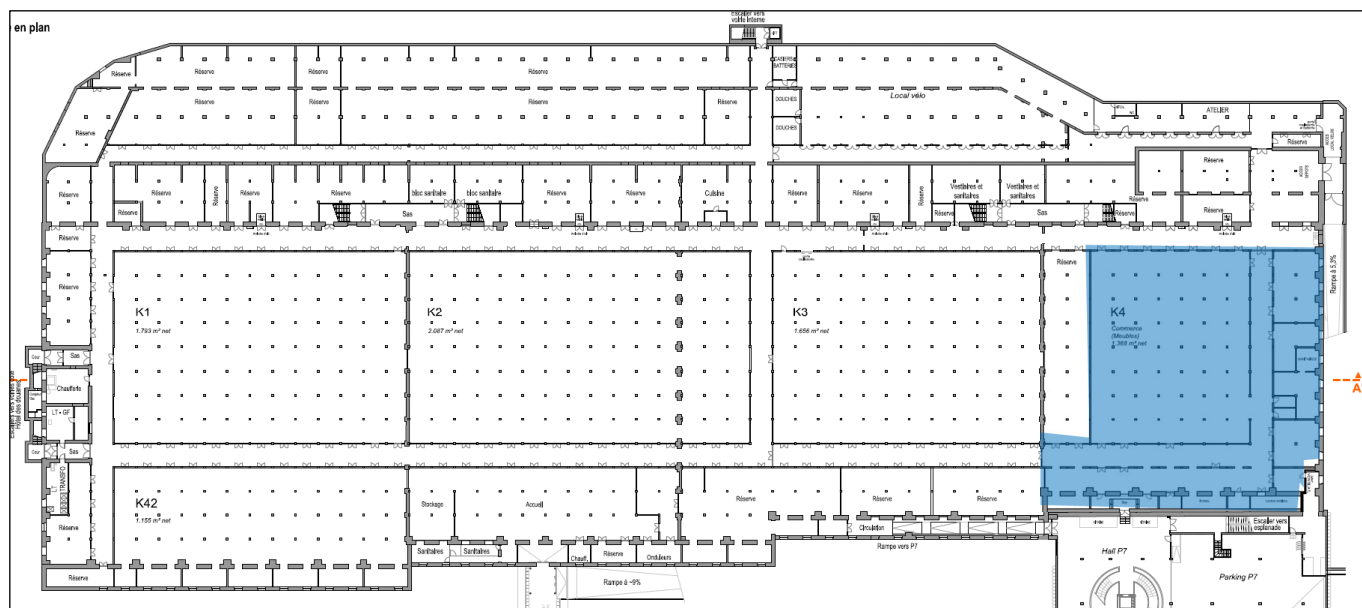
, Bâtiment A, situation existante de droit – rez-de-chaussée
